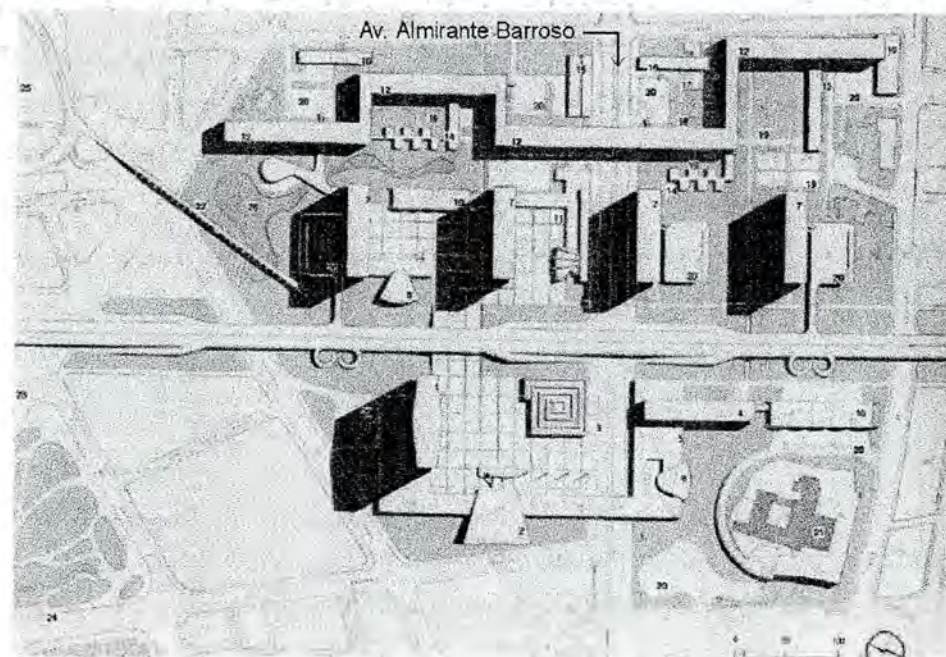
Planta geral e corte 1º Plano de Urbanização.
